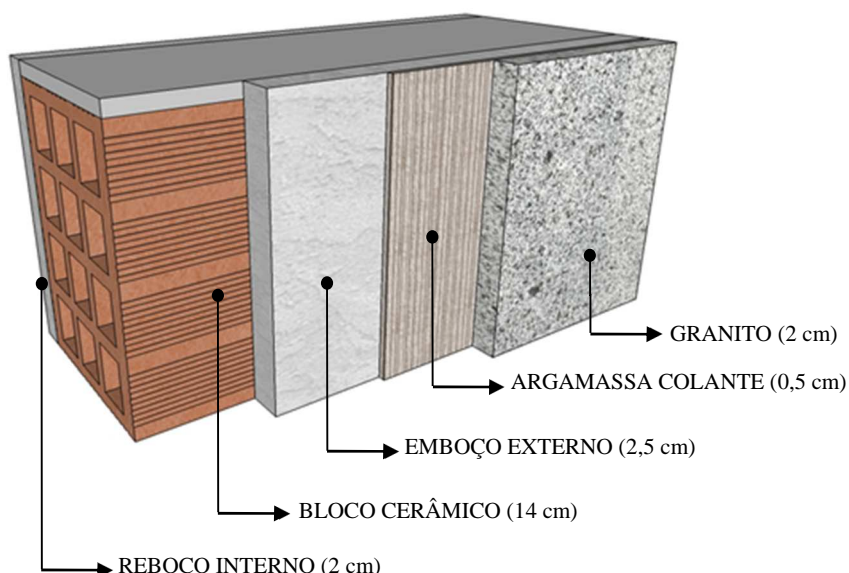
Camadas do sistema de fachada-cortina com as espessuras adotadas. (Fonte: Elaborado pela autora)
